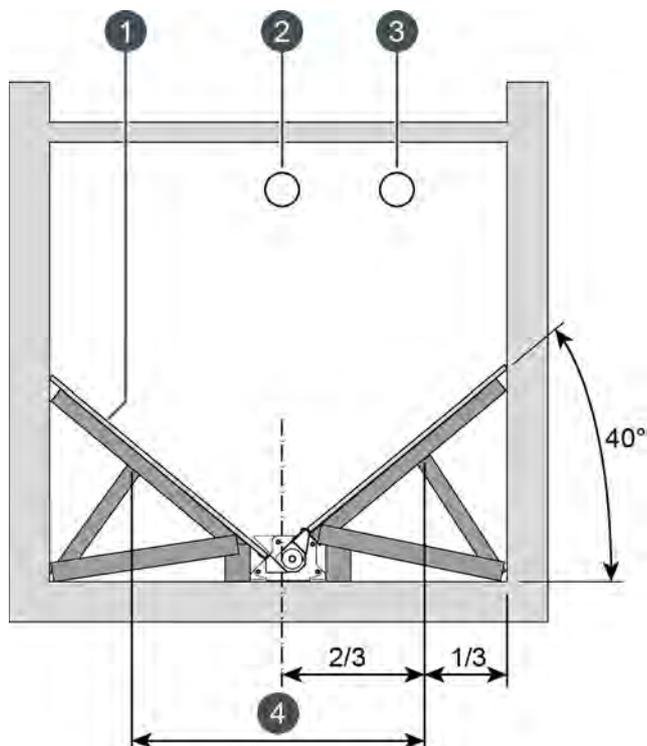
Construction du plancher incliné pour la vis d'alimentation
